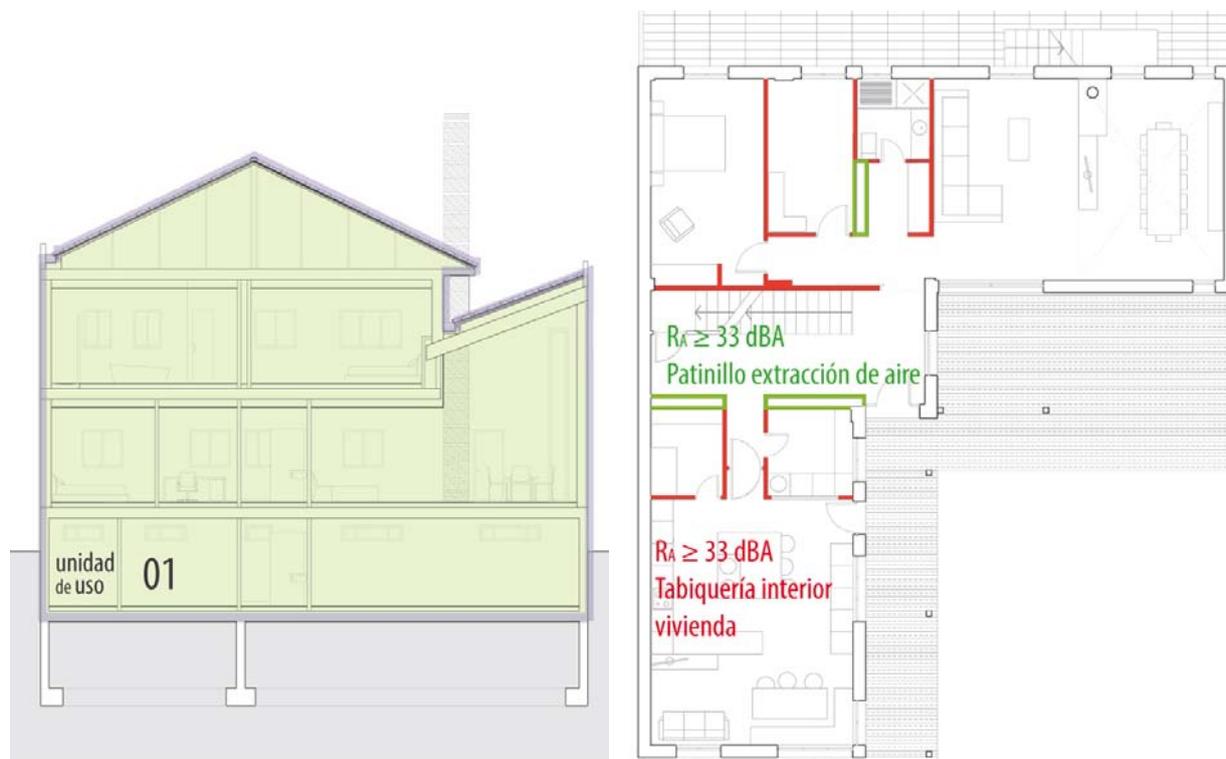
Sección vivienda y planta baja con indicación de exigencias aplicables a la tabiquería interior y a los conductos de extracción de aire.
